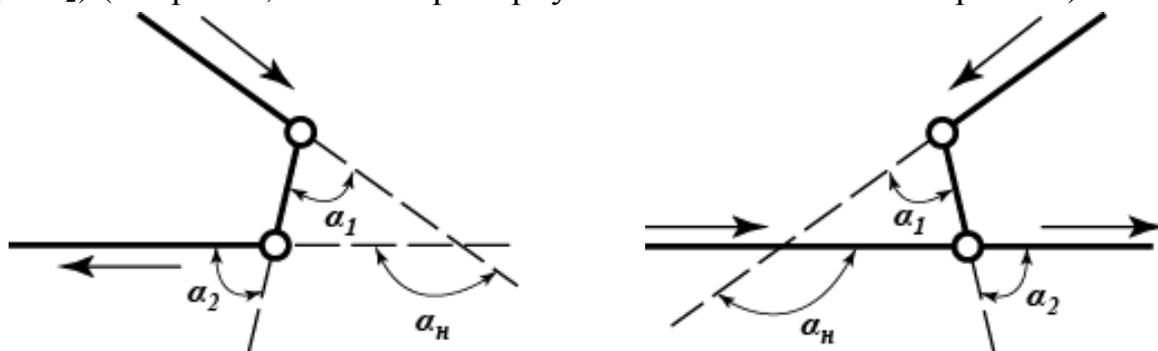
Схемы поворота трубопроводов и присоединения боковых веток с устройством дополнительного участка.
